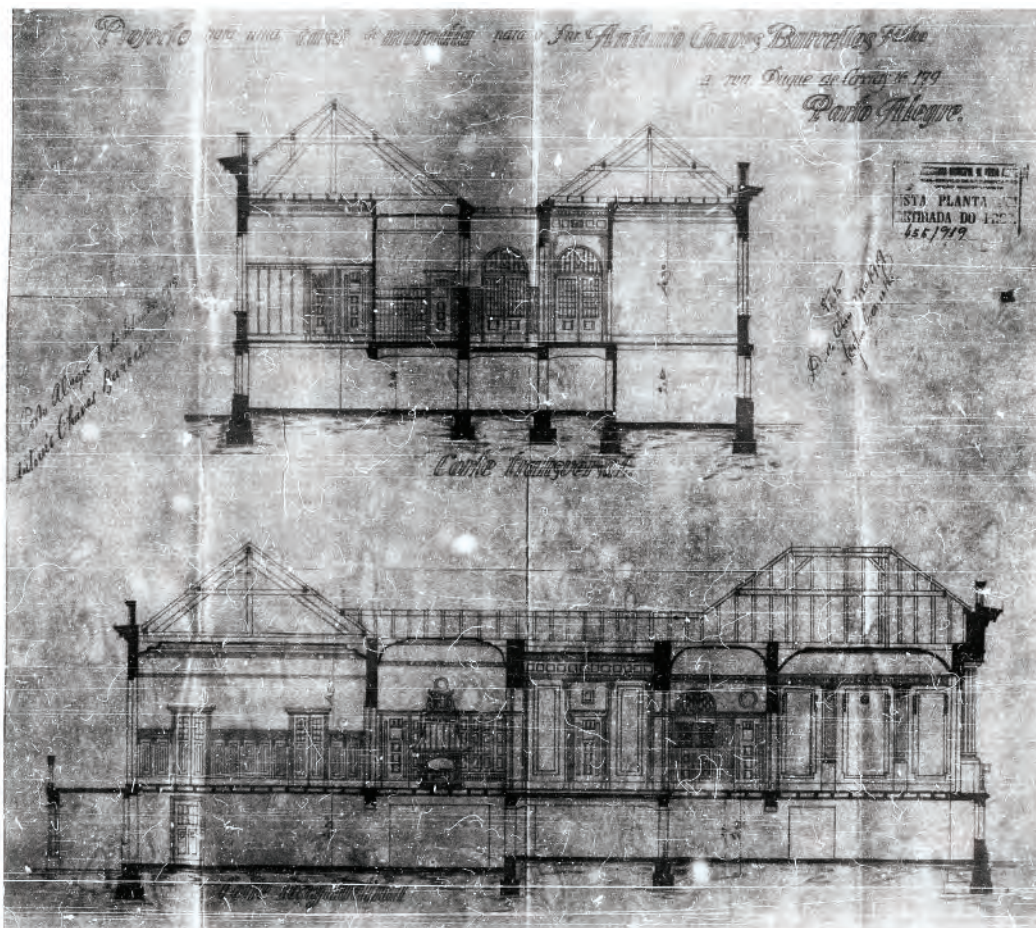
Cortes originais transversal e longitudinal. FONTE: Acervo do Arquivo Público Municipal de Porto Alegre.
